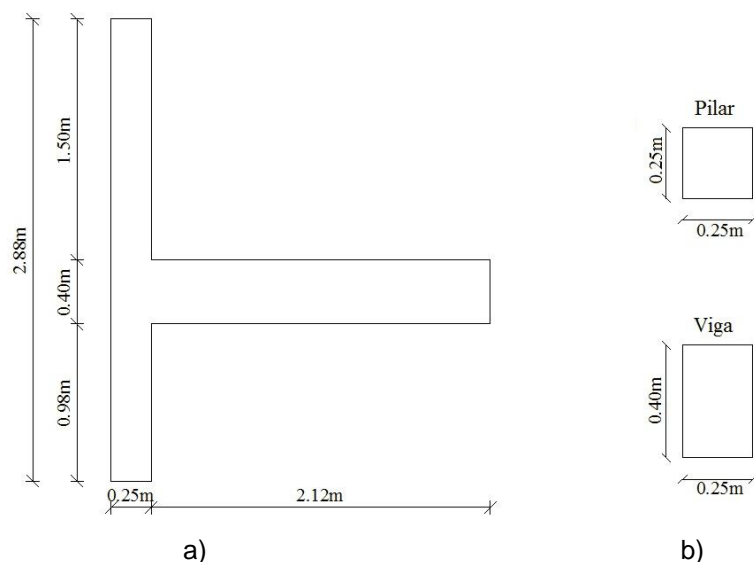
Dimensões do Nó: a) provete; b) secções transversais;
